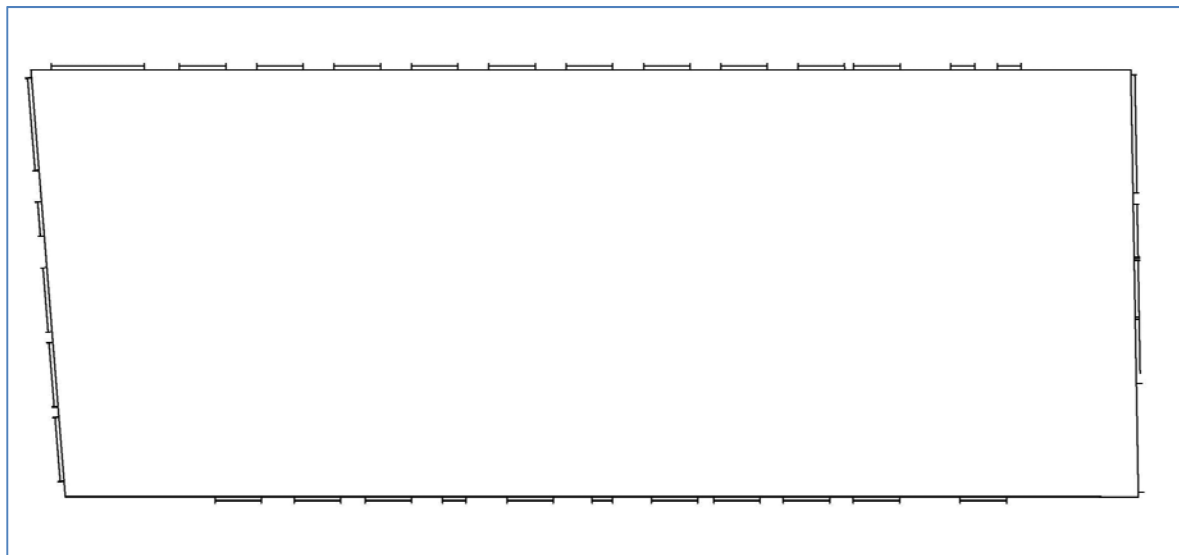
Silueta efectuada a partir del plano de planta primera del Proyecto de Ejecución. (Efectuada por la cara interior de la fachada).
